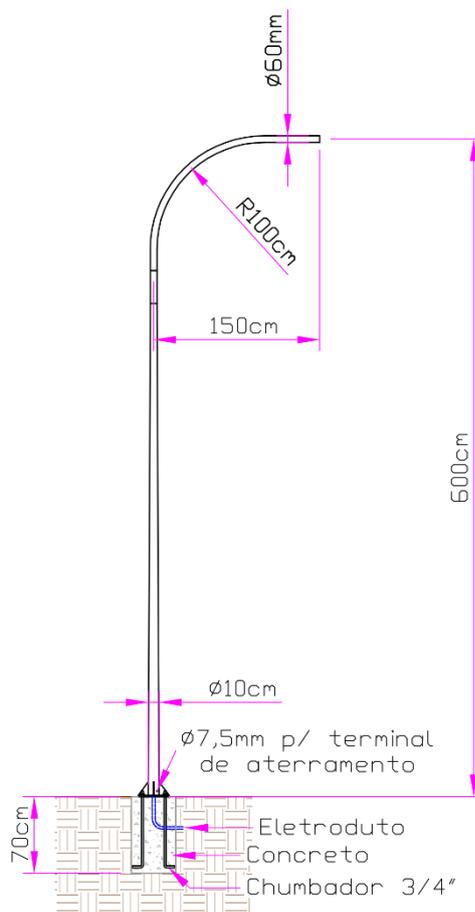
Poste metálico engastado padrão 6m útil braço simples
